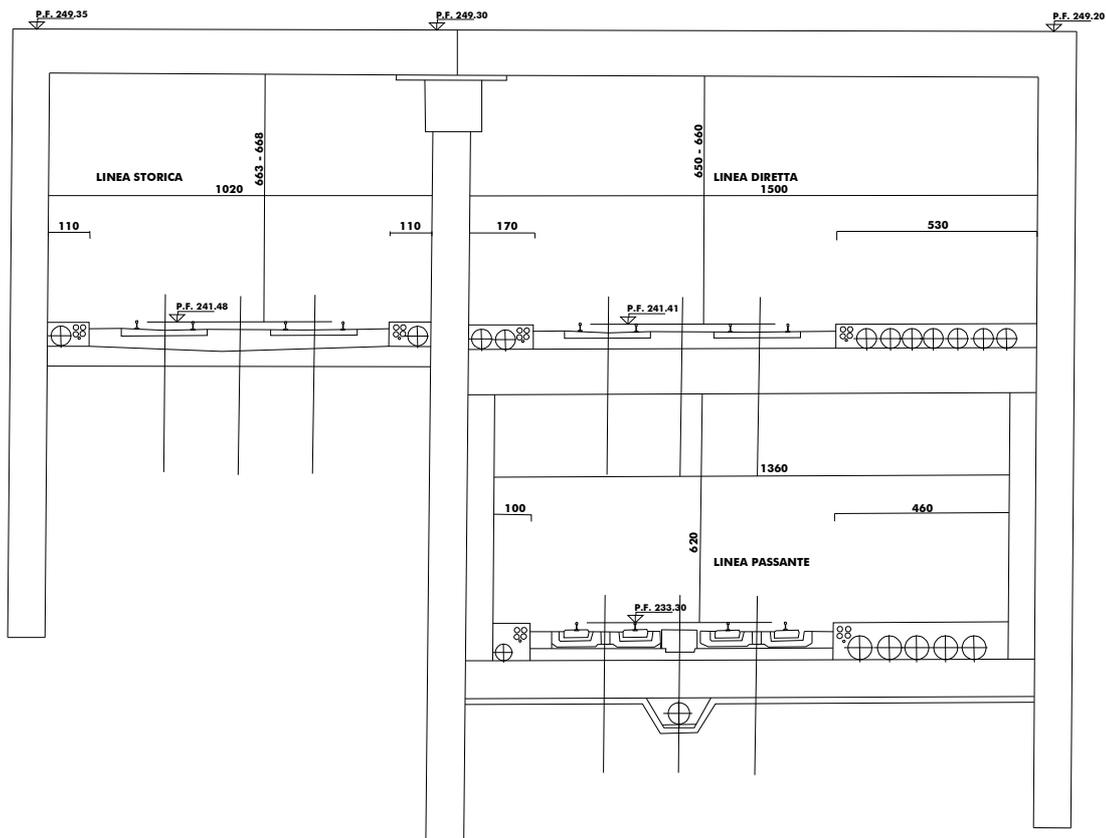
Sezione tipo gallerie Storica/Diretta/Passante
